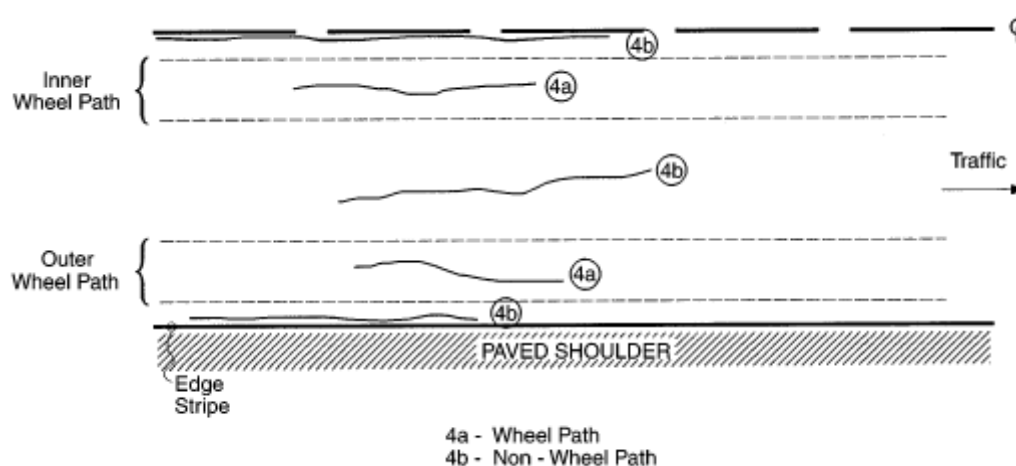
10 Tipos de fisuración longitudinal
